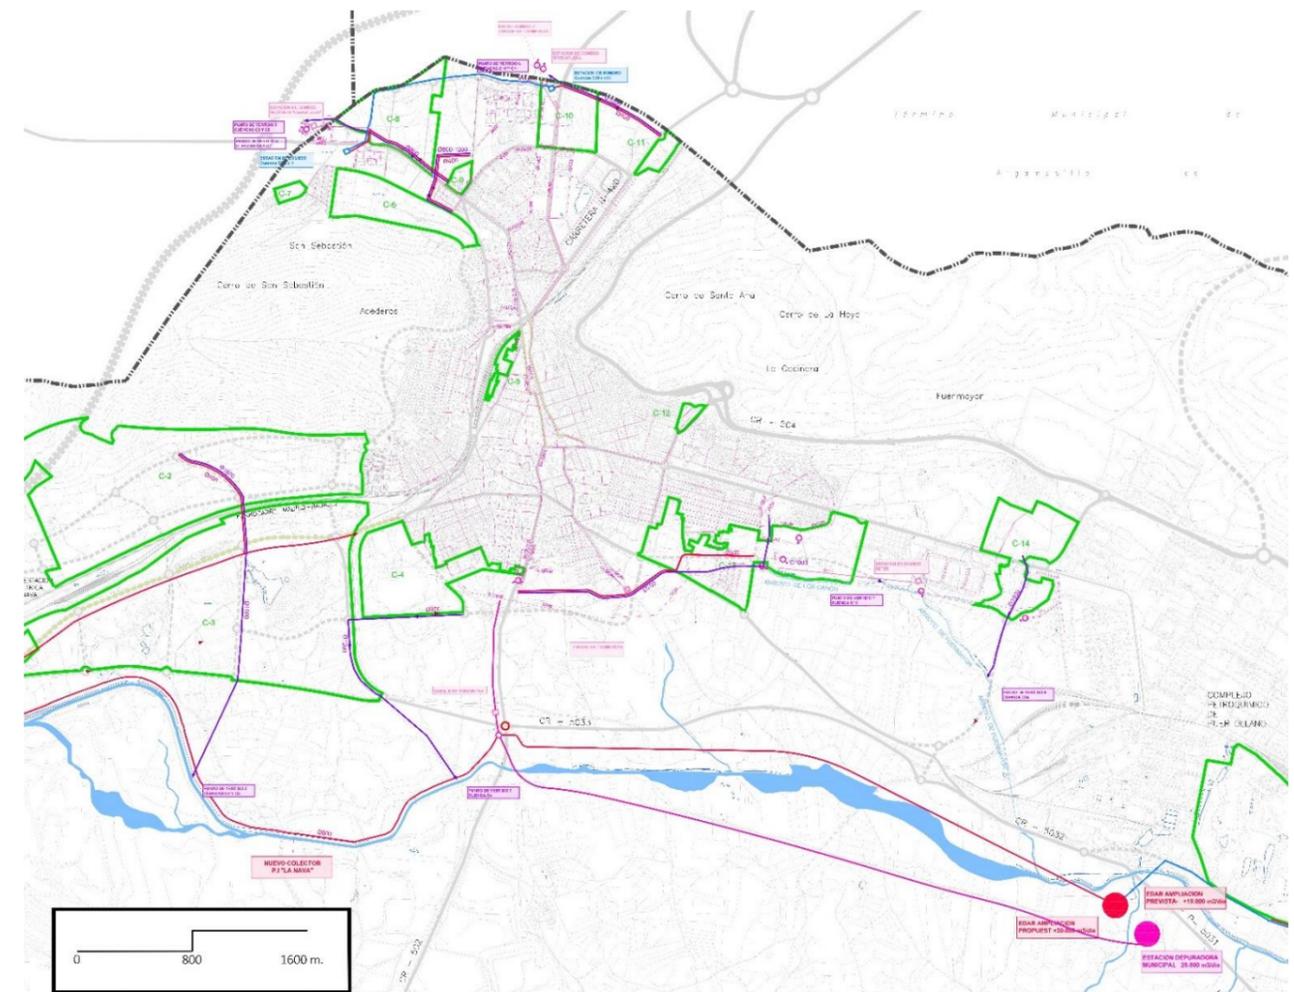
Red de Saneamiento de Puertollano, plano del 2009. Fuente: POM de Puertollano.
